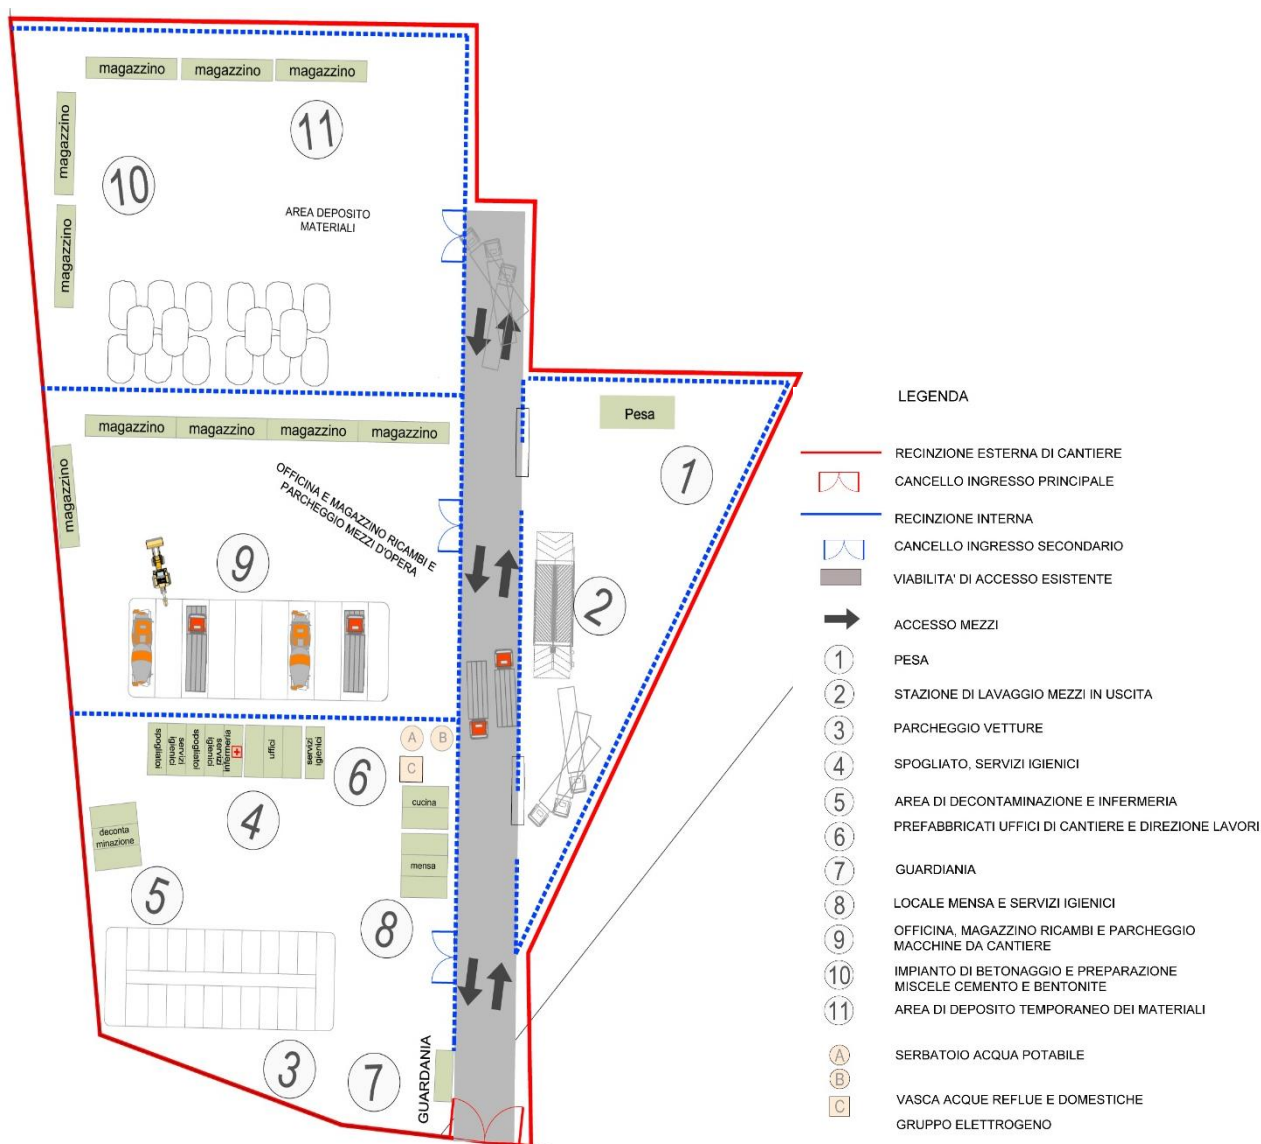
Planimetria generale dell'area logistica e di cantiere.
